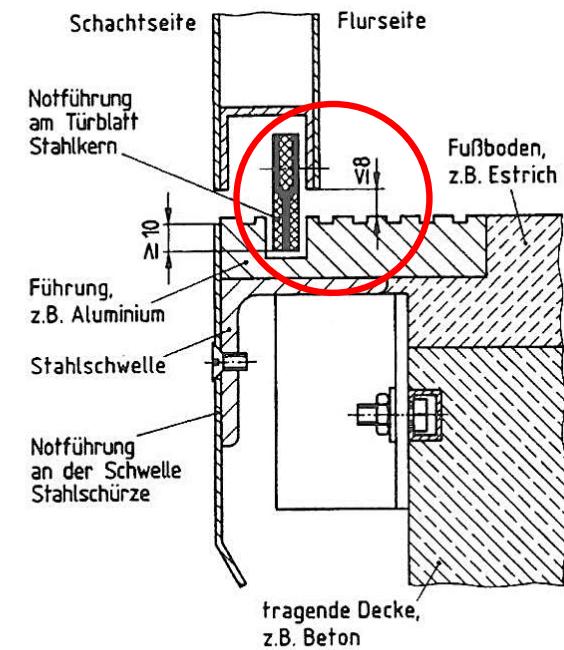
Untere Führung einer horizontal bewegten Schacht-Schiebetür mit
